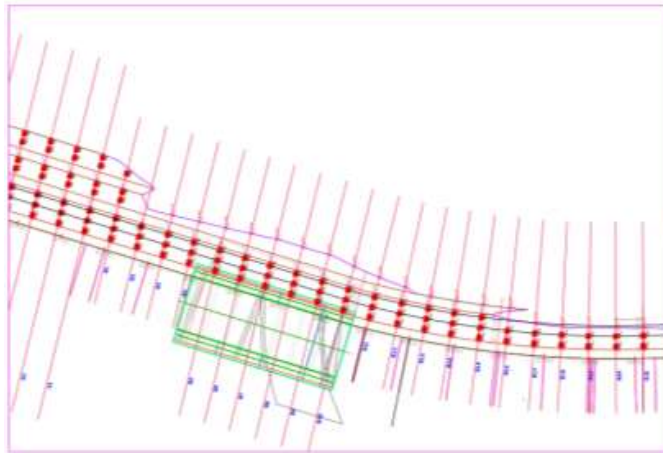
Plano anclajes san Bernardo sección b, fuente propia.
